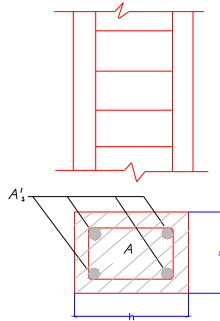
配置箍筋的轻骨料混凝土轴心受压构件截面
